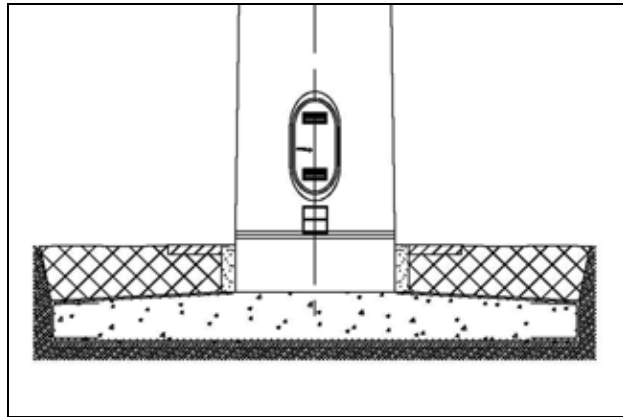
Schéma-type d'une fondation (source : GAMESA, 2014)
